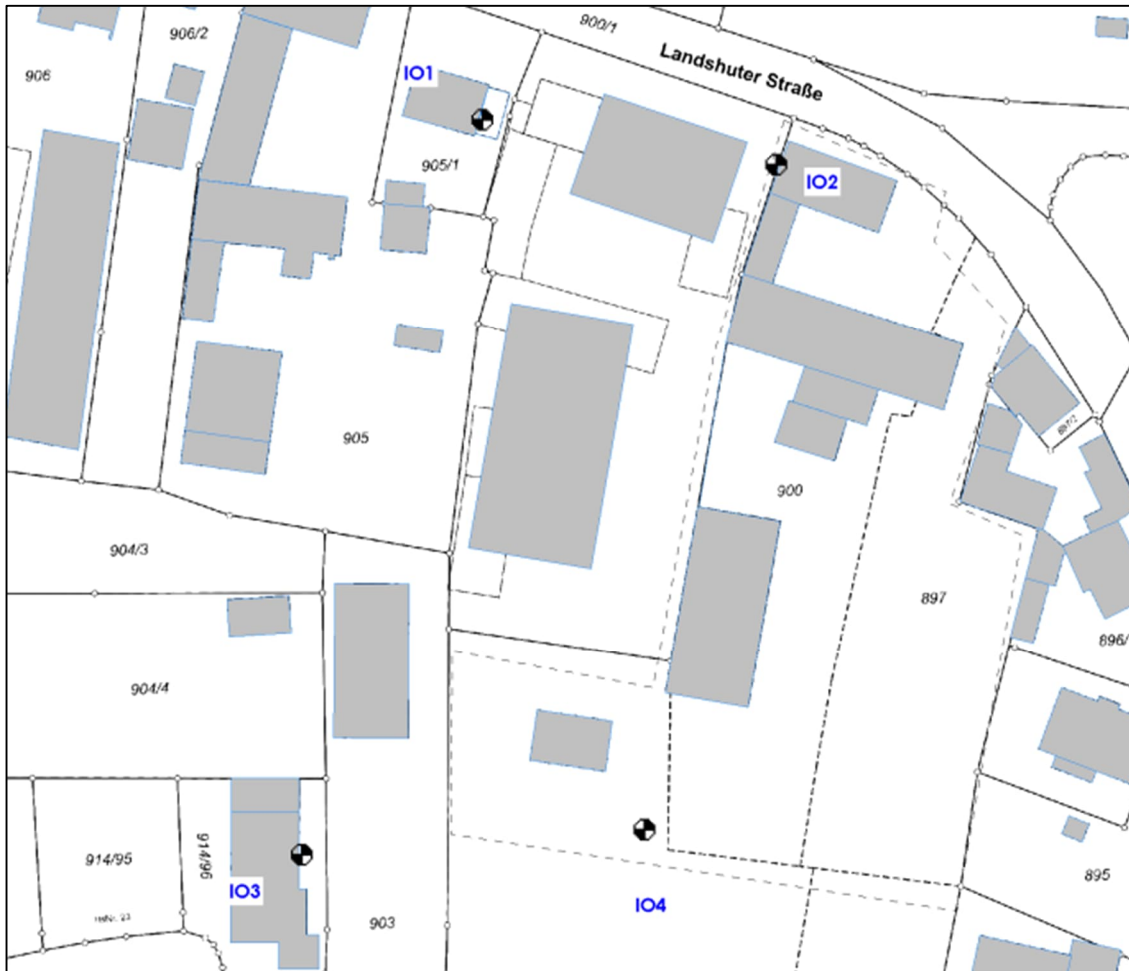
Lageplan mit Darstellung der maßgeblichen Immissionsorte (IO)
